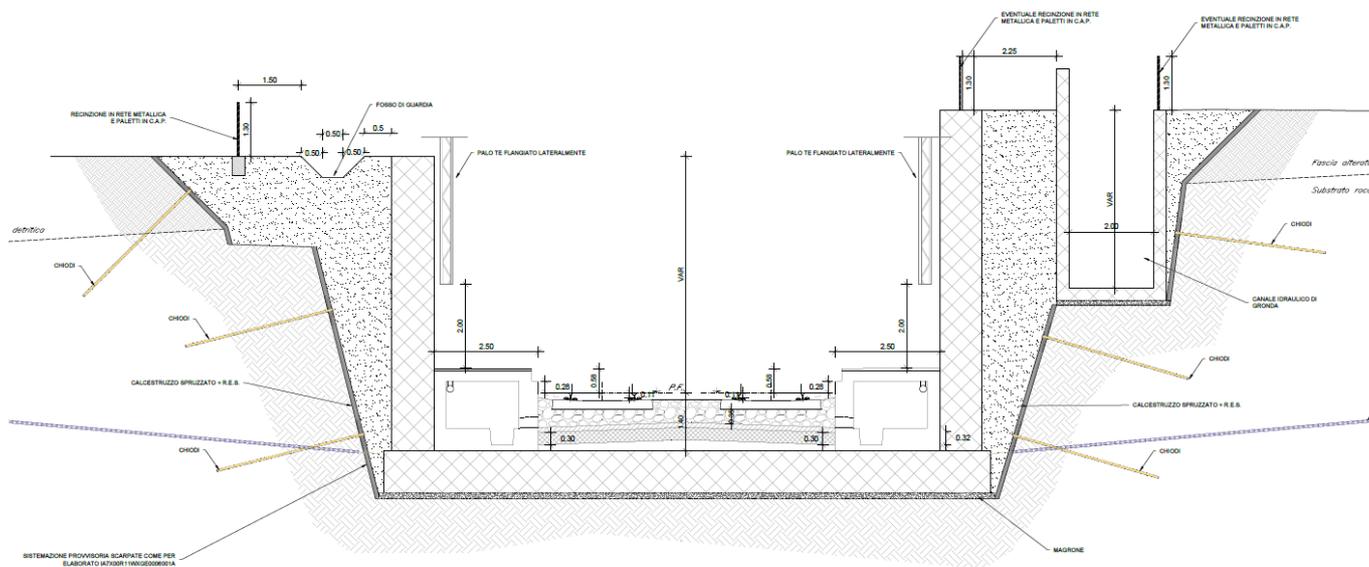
Sezione tipo in Trincea con muri ad U a paramento verticale
